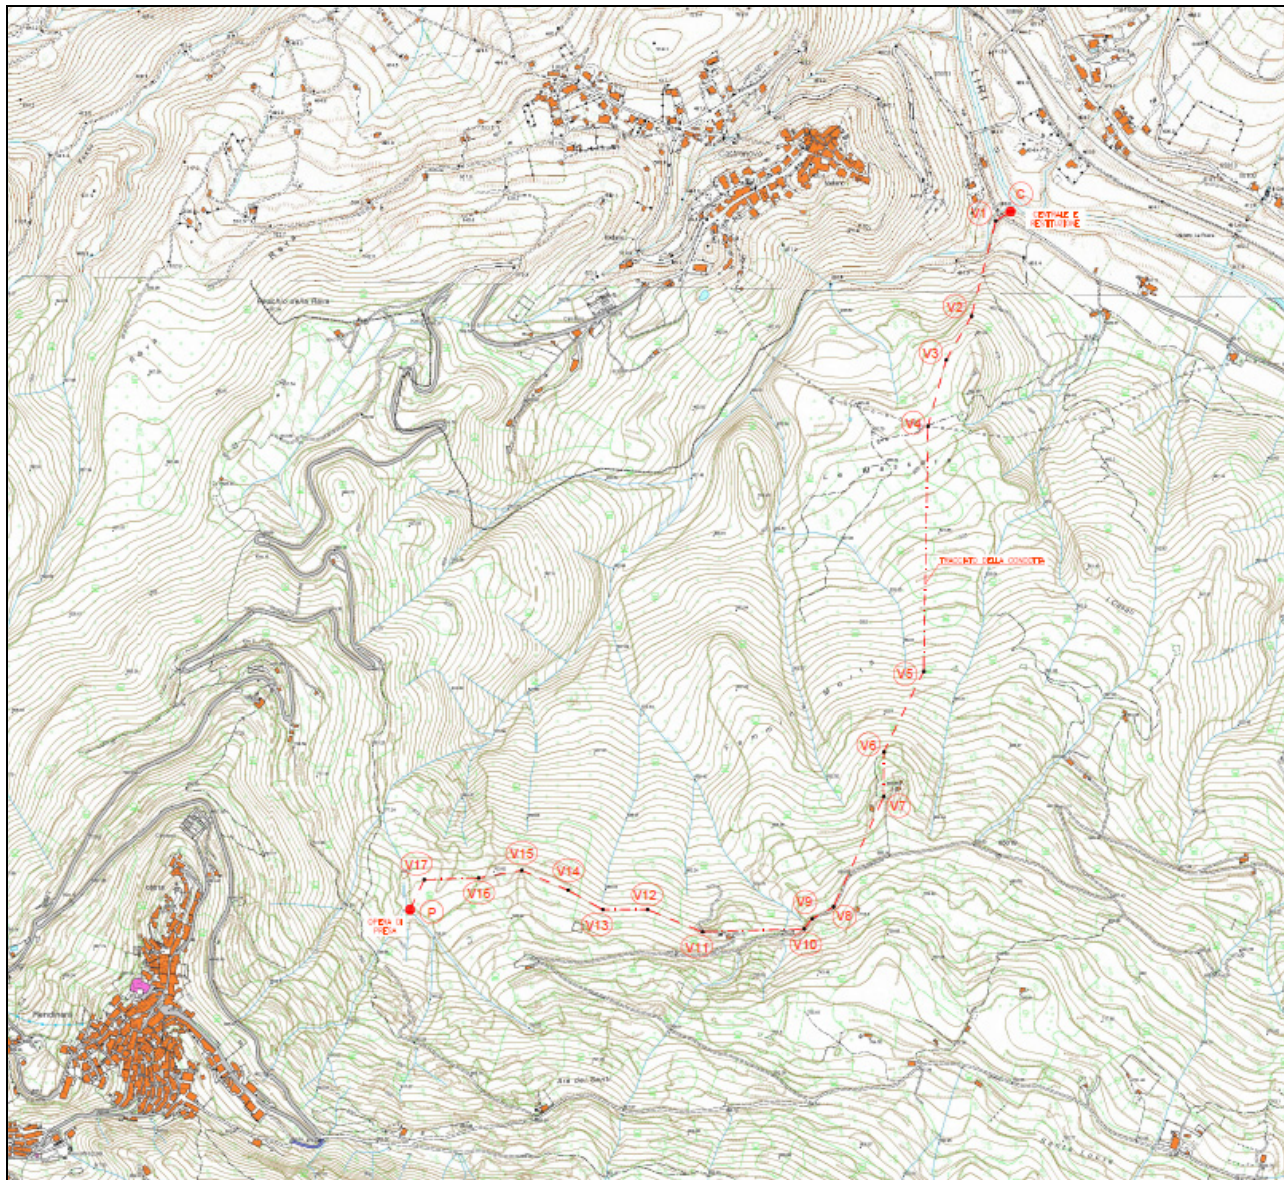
stralcio della CTR 377102 con ubicazione dell'area oggetto di studio
